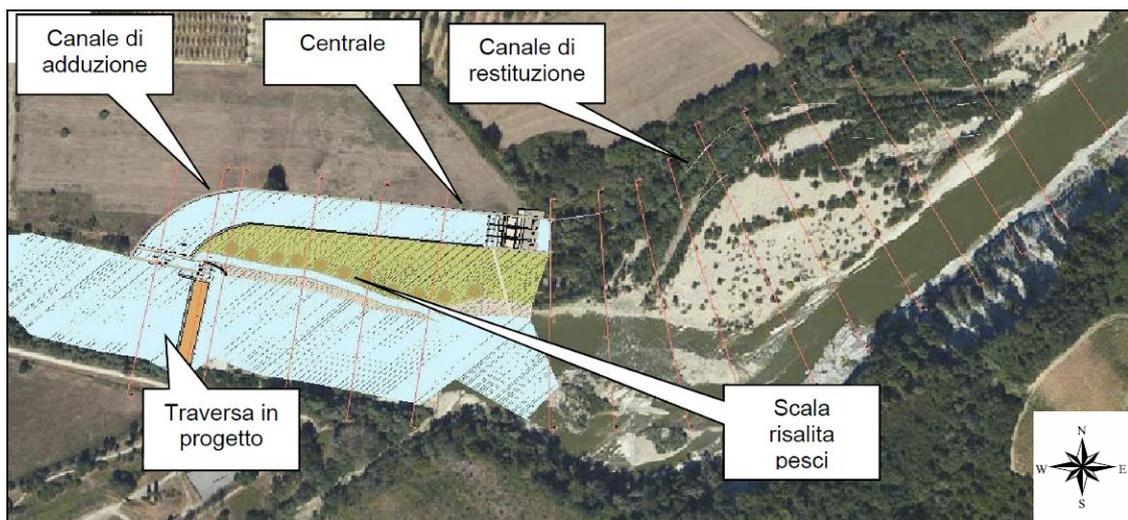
Planimetria delle opere a progetto su foto aerea
